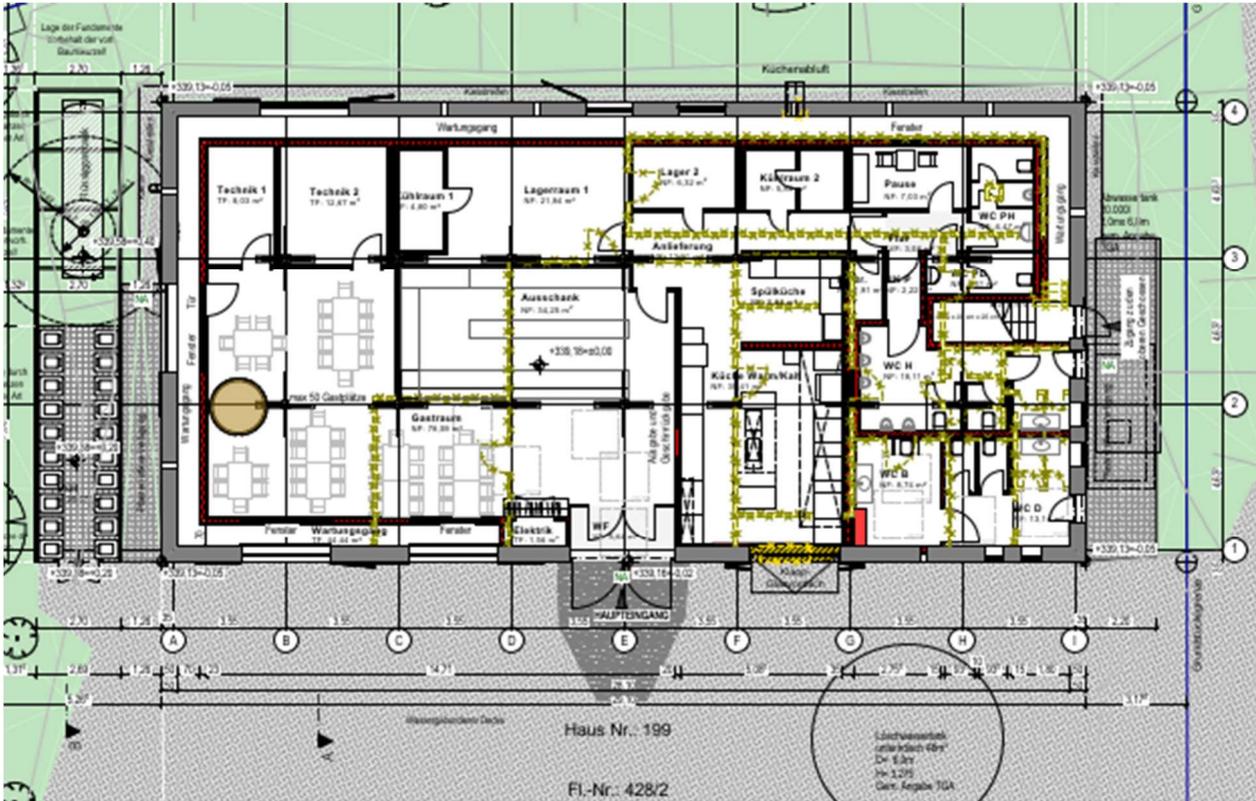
geplantes Erdgeschoss (Grundriss o. Maßstab)
